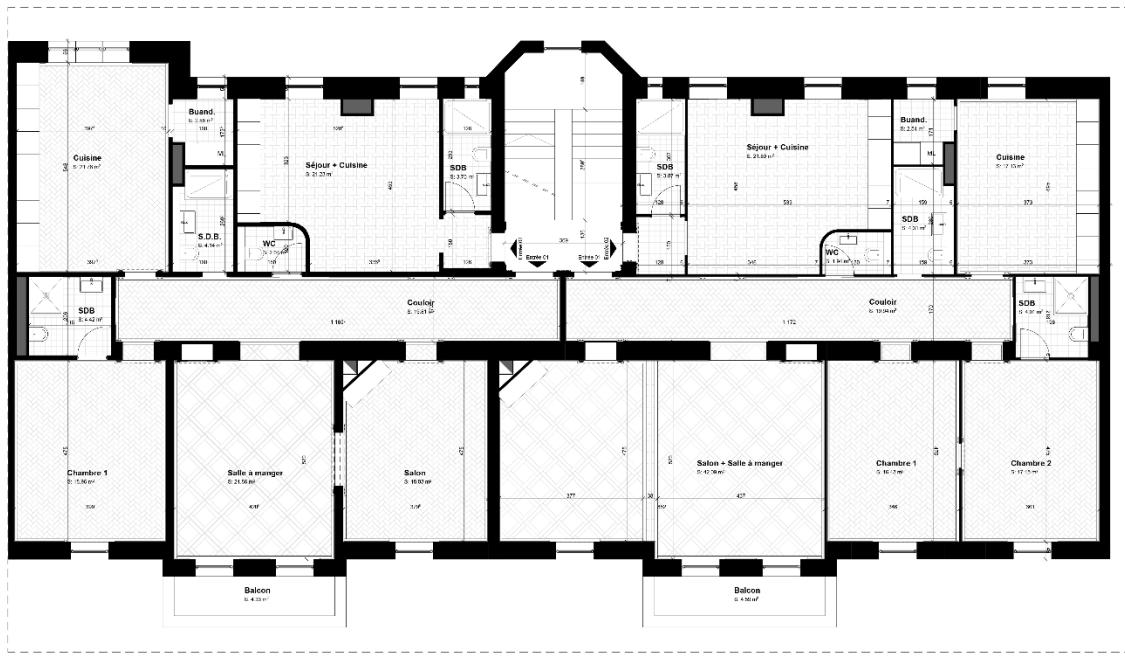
Plan 3<sup>ème</sup> Etage – ML 13-G, ML 13-D – Proposition de transformation
